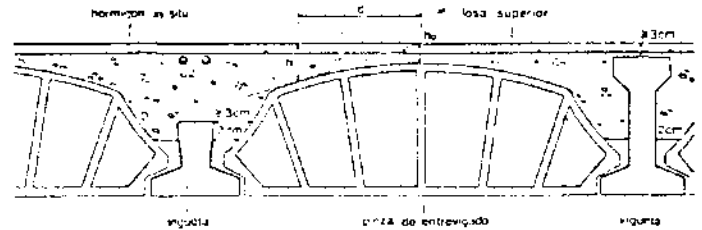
CONDICIONES GEOMÉTRICAS DEL FORJADO
